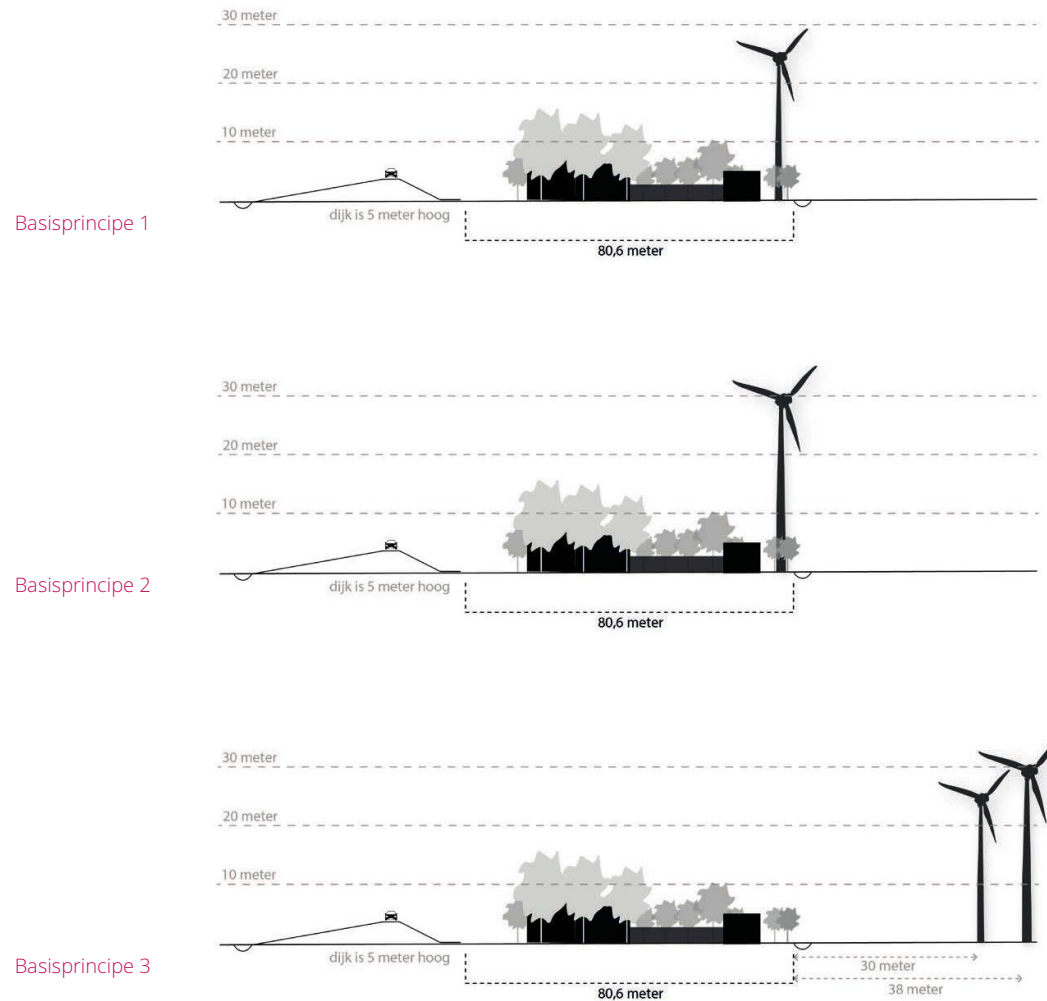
| (rechtsboven) Schets van het voorbeelderf met daarin de hoogten van bebouwing en beplanting.
